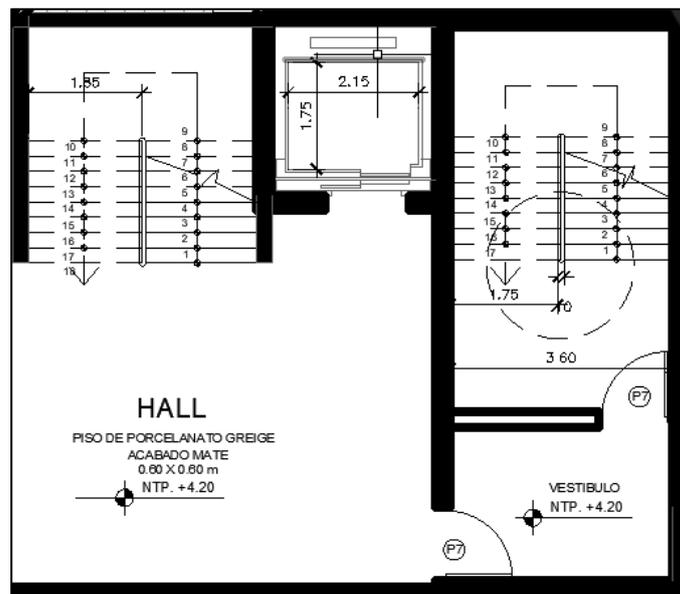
Planta primer nivel del proyecto-zona educativa- escalera de evacuación.
